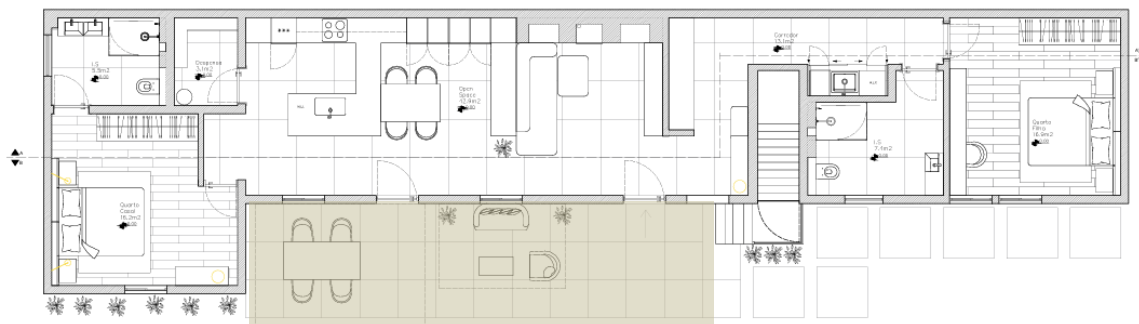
Planta de apresentação Zona exterior Fonte: Autor
